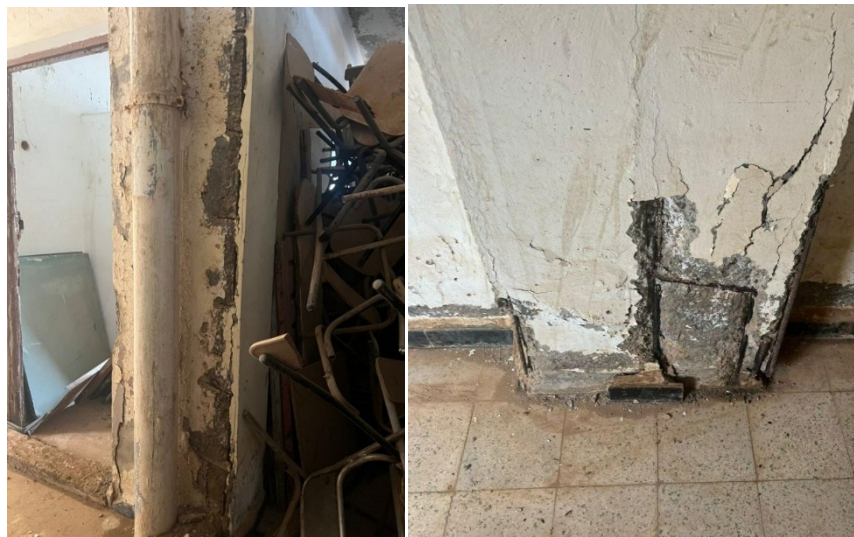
Poteaux intérieurs - décollement d'enduit, fissuration et amorce de corrosion
